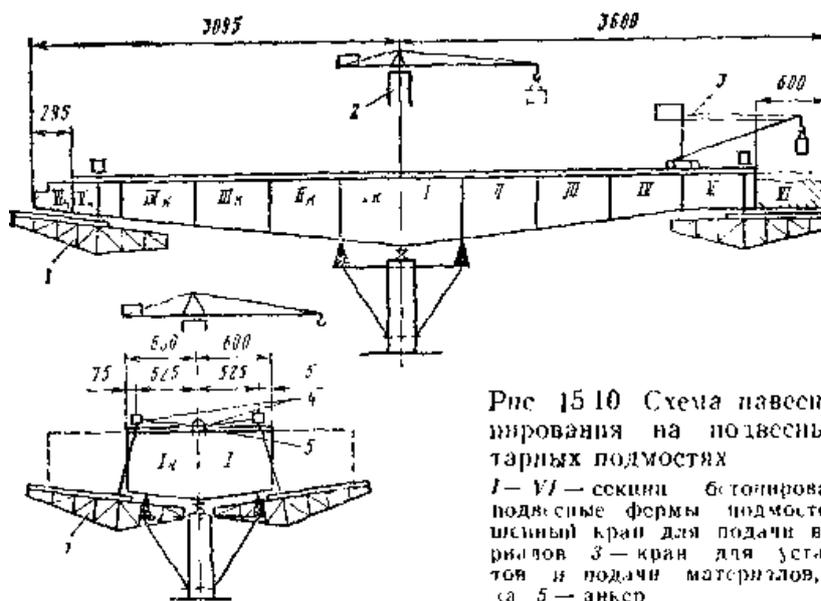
Схема навесного бетонирования на подвесных инвентарных подмостях
